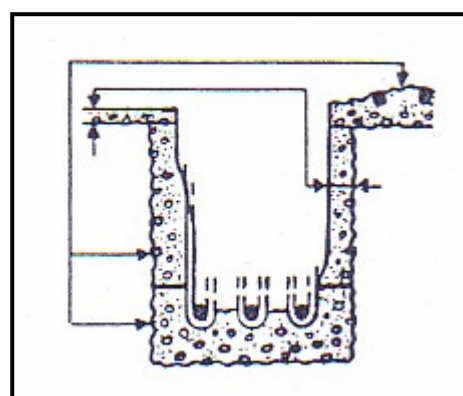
Reconstitution du fond et des joues de la poutre [12].
